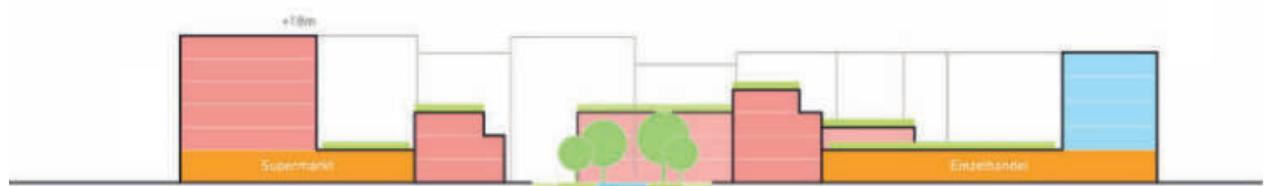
Schlüsselprojekt Passagenblock: Vorzugsvariante 3.2 - Schemaschnitt
